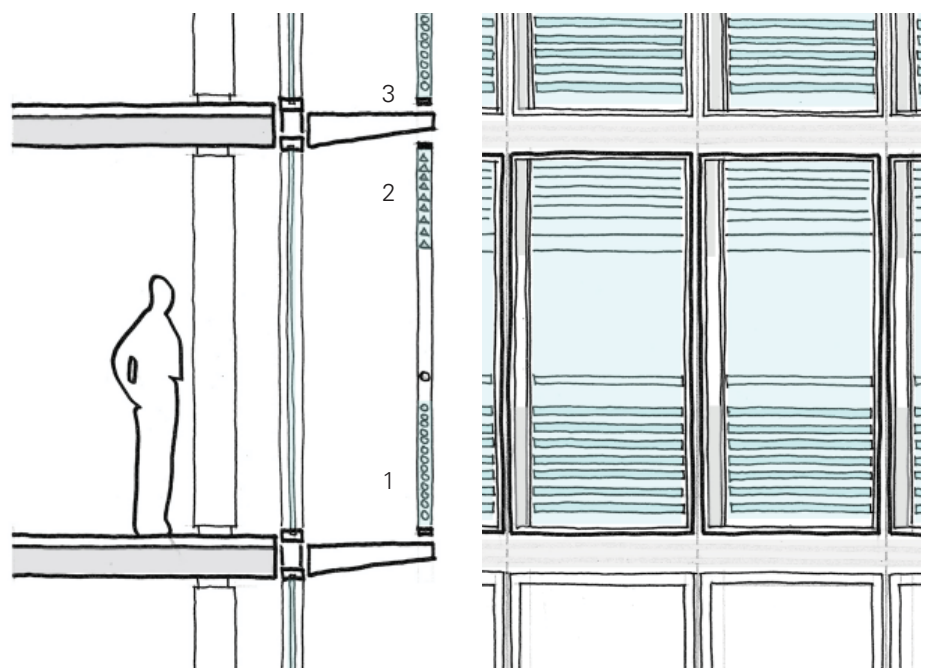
Vertikalschnitt und Teilansicht des in Abb. 2.13 dargestellten Fassaden-
